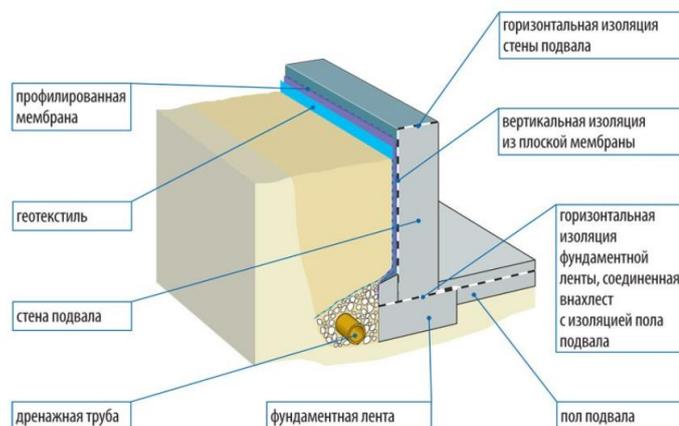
Гидроизоляция фундамента. (источник: <https://aquavis.ru>)
